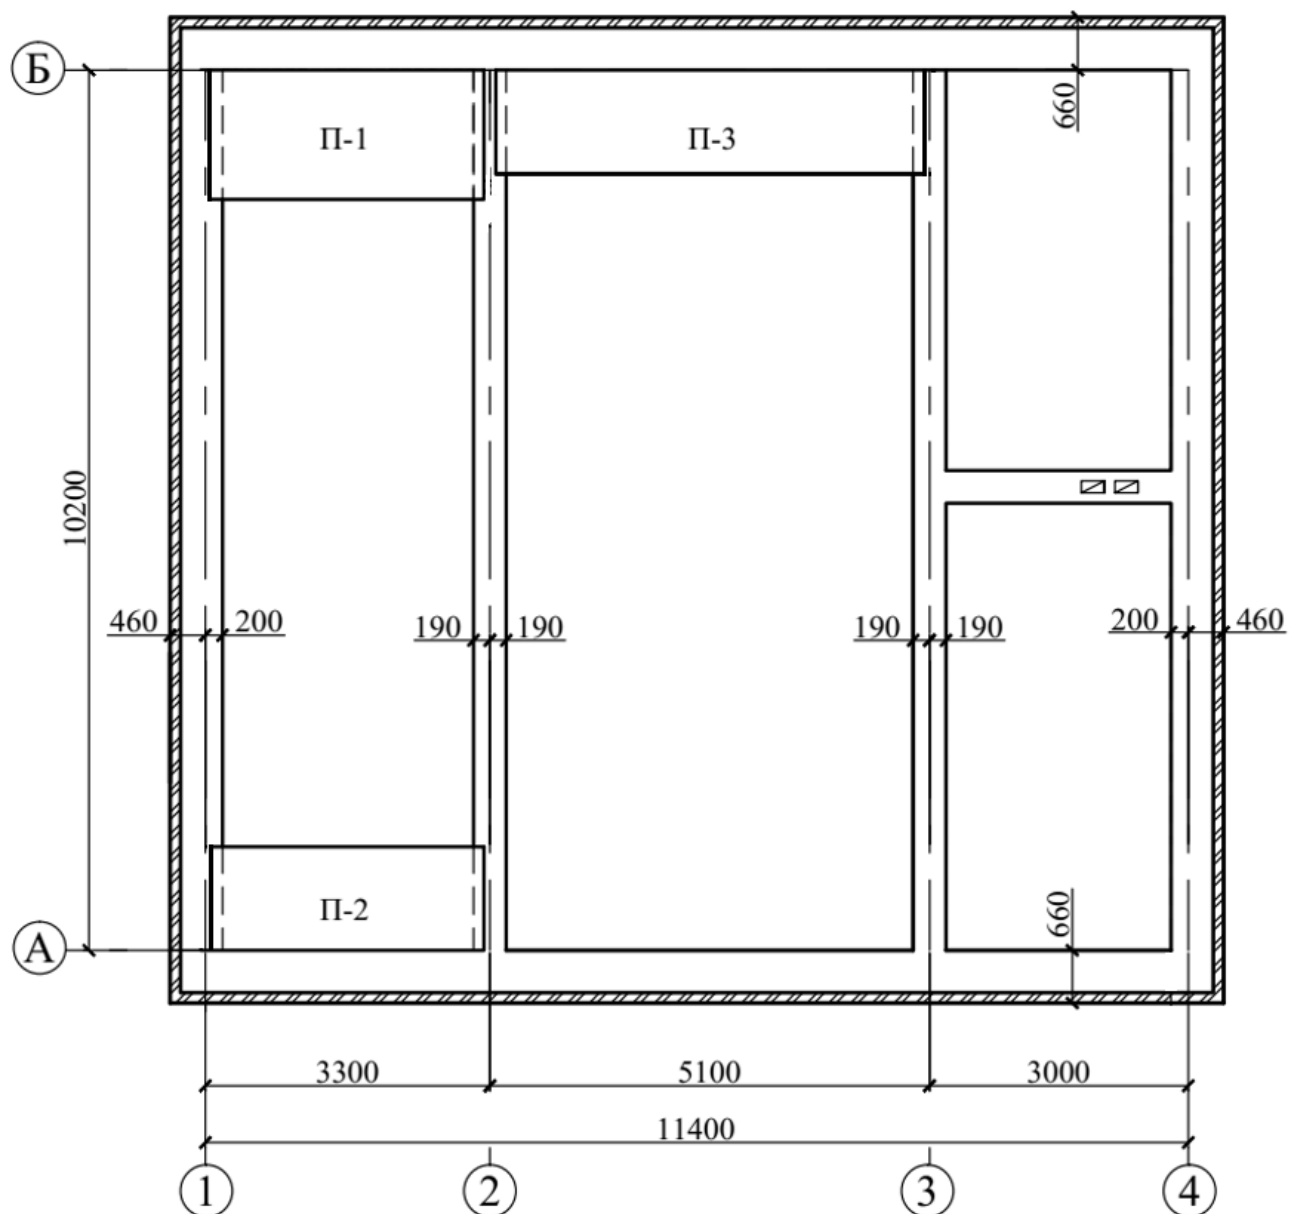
Пример выполнения конструктивной схемы здания с поперечными несущими стенами
